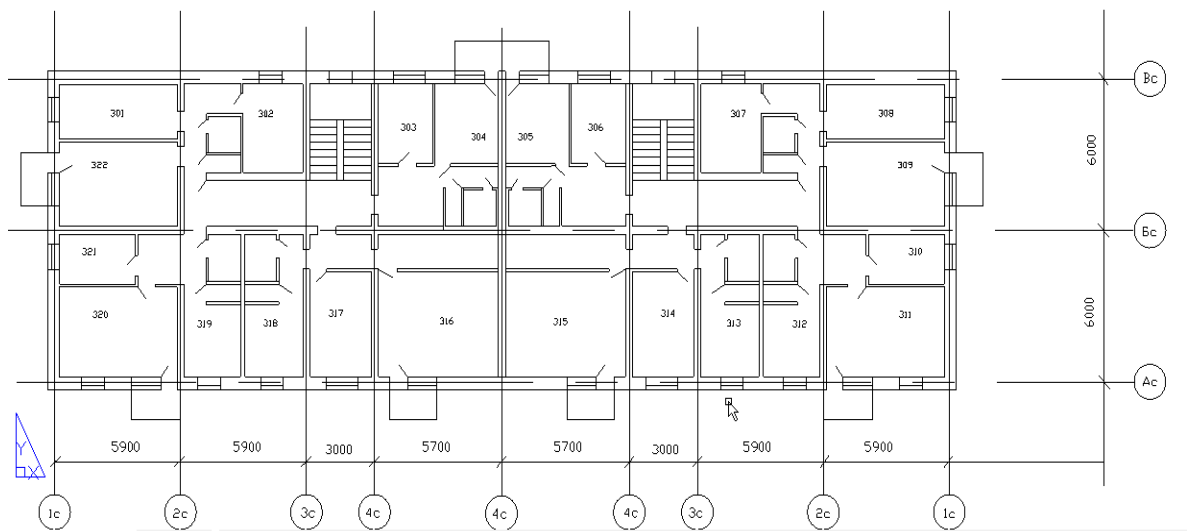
План типового этажа рассматриваемого жилого дома.
